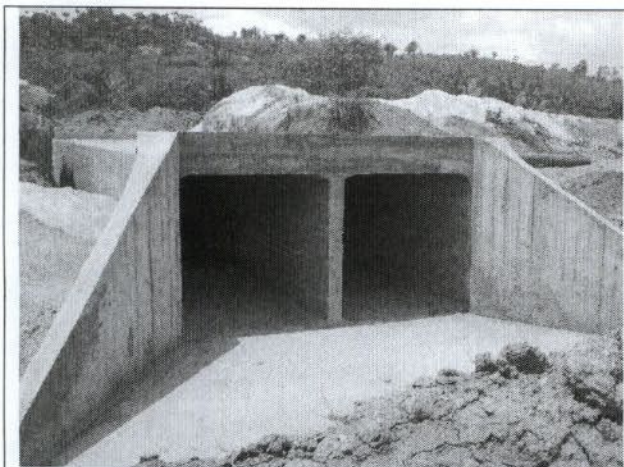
Instalação de bueiro celular duplo onde deveria haver uma ponte.
